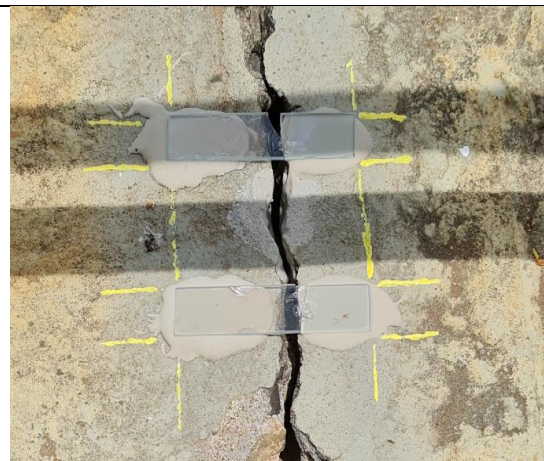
QUEBRA DE PLACA DE VIDRO INSTALADA NO MURO DE ARRIMO DE ACESSO A CASA DE FORÇA
